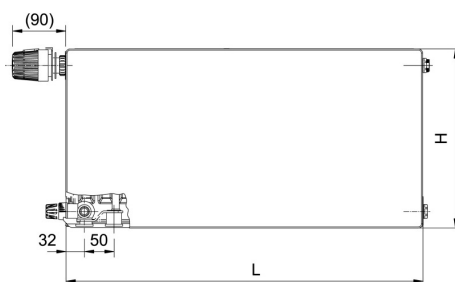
Způsob zapojení otopného tělesa Korado RADIK RC PLAN VK [32]
